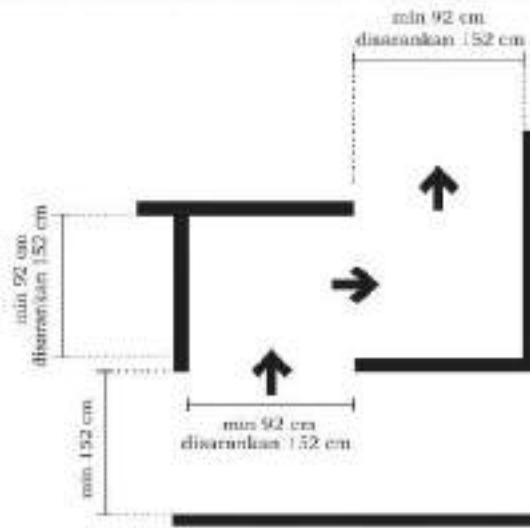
Lebar efektif koridor dengan pegangan rambut (*handrail*)
